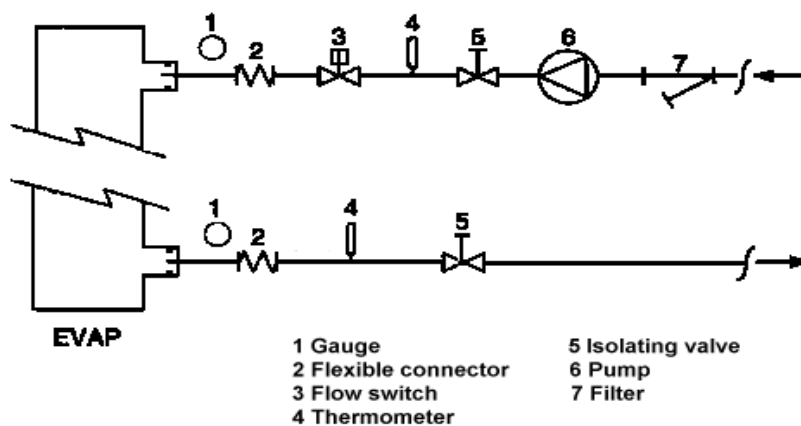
Wasserrohranschlüsse für Verdampfer
